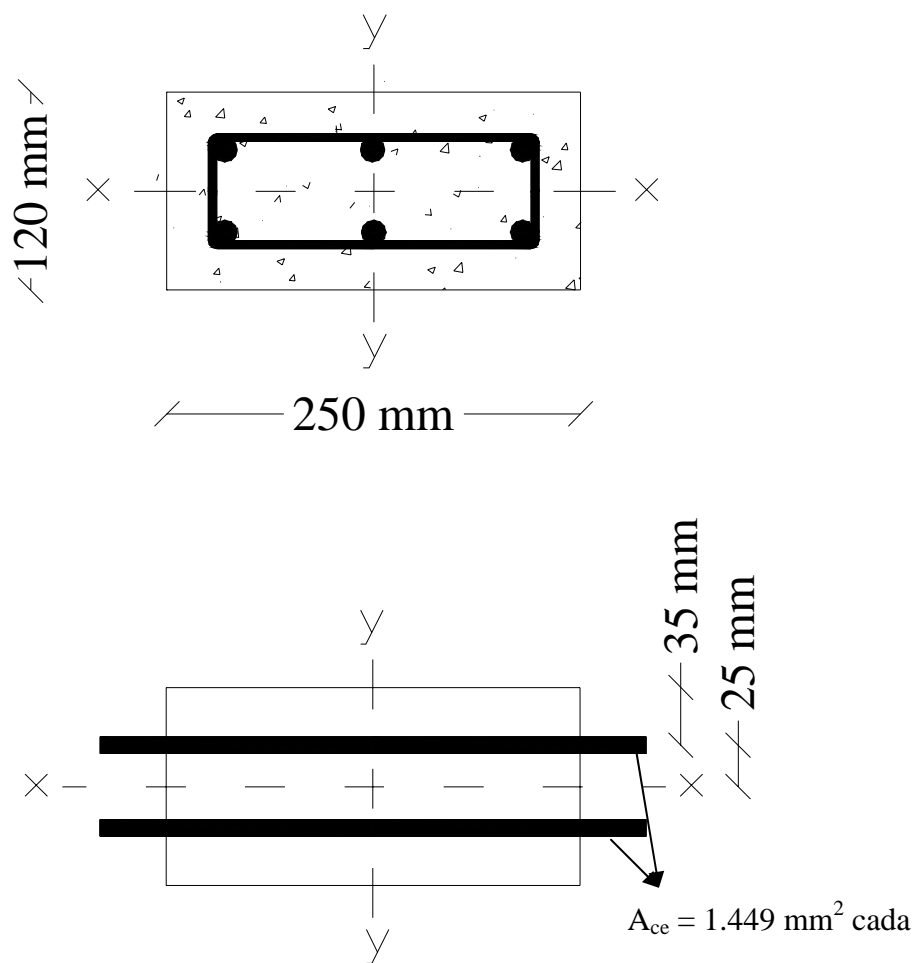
Homogeneização da seção transversal dos pilares ensaiados
